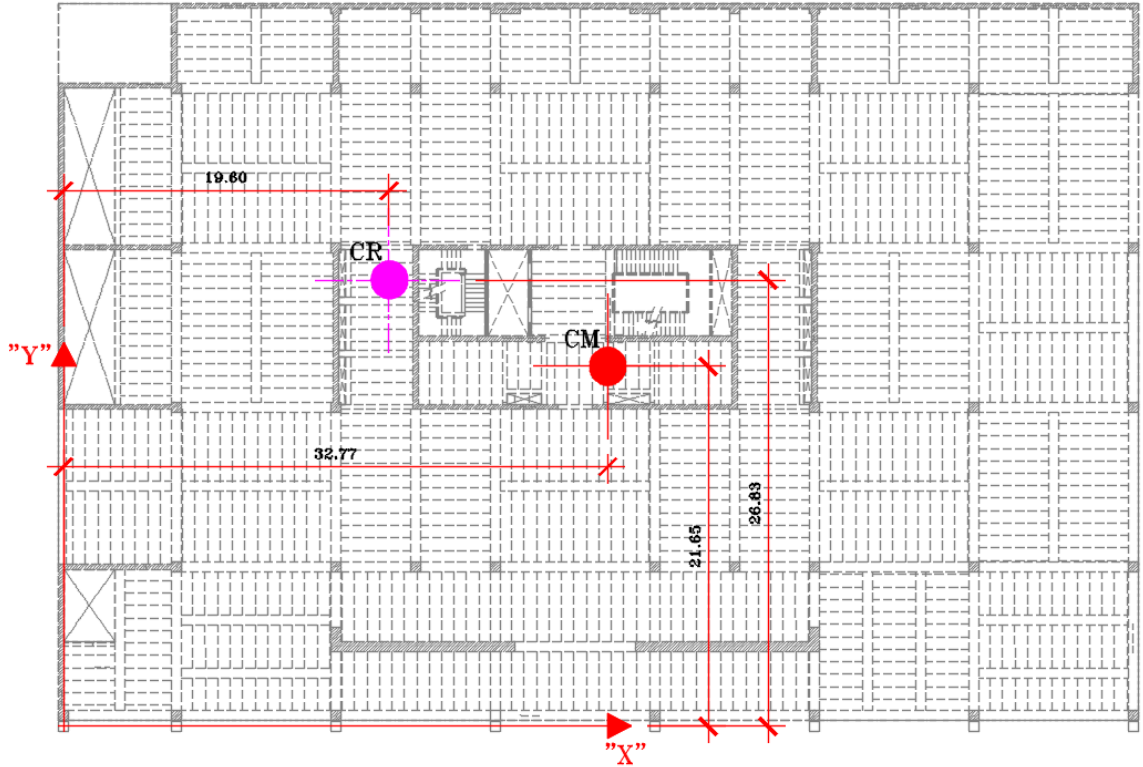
Centro de masa y rigidez en planta de primer nivel.
